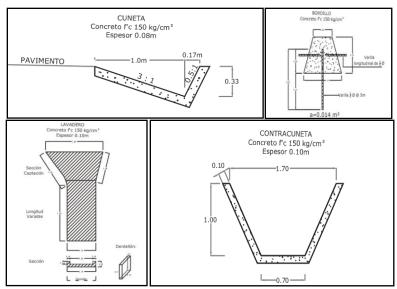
Sección tipo de las obras de drenaje complementarias.
